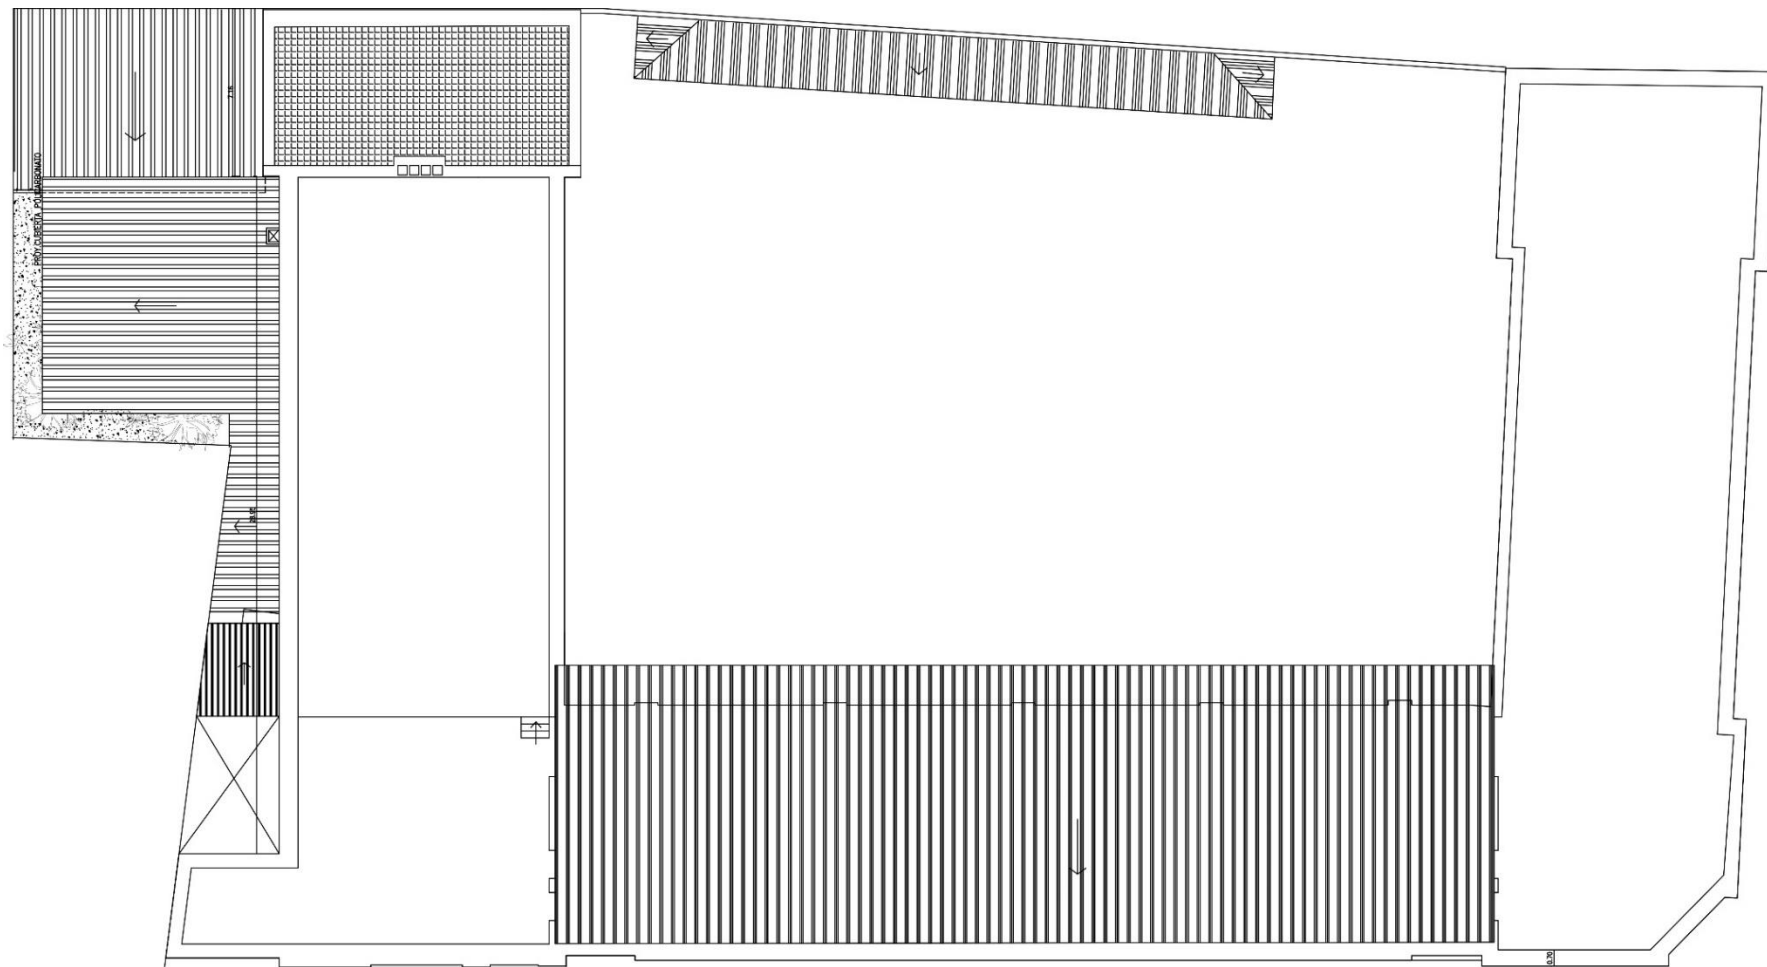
Planta Cuarto Nivel previo a la intervención. Fuente: Elaboración Propia
